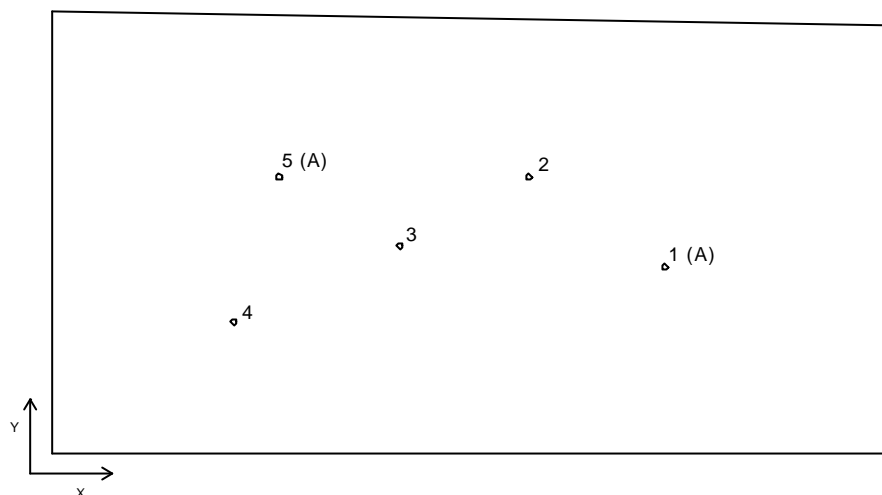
Pontos de medição na parede de concreto da Câmara de Recepção.
